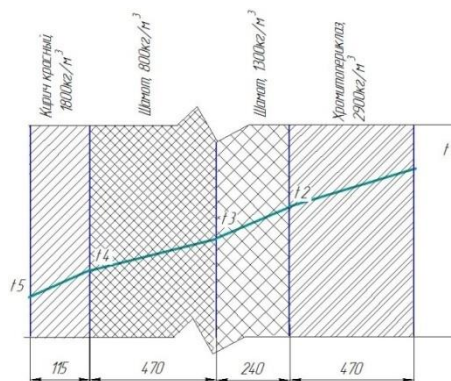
Разрез футеровки стены на 38–41 позициях
